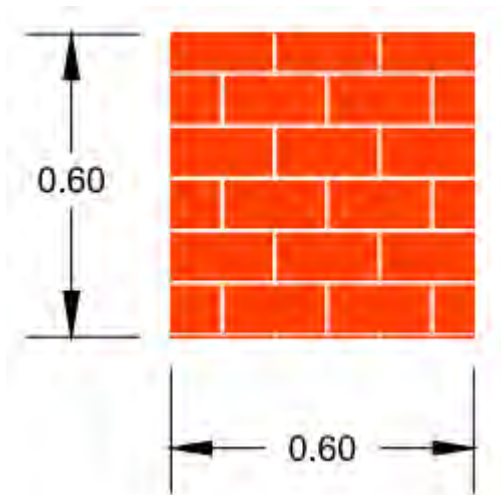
Murete sin reforzamiento (Tipo M1)
